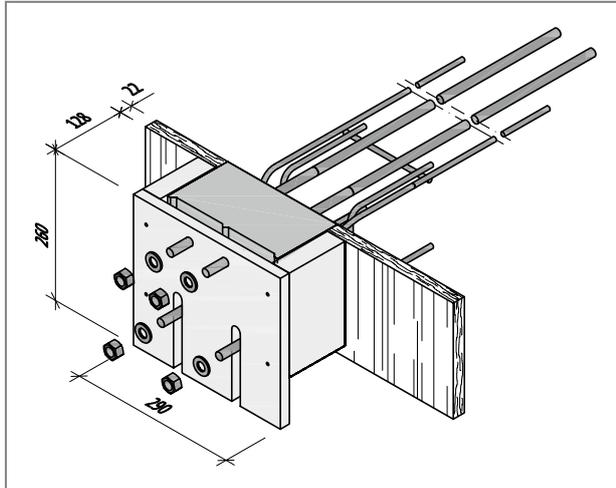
Schöck Isokorb® XT Typ SK: Darstellung mit Einbauhilfe
